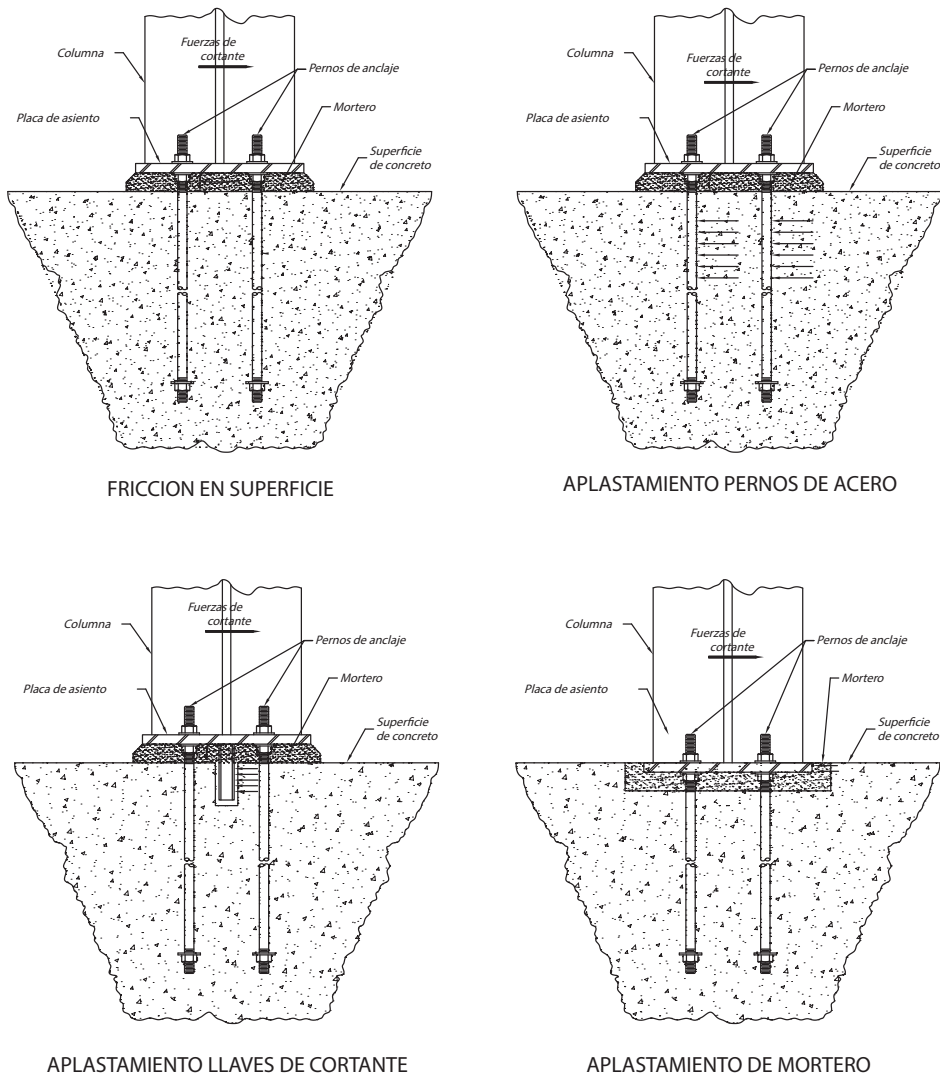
Mecanismos de transferencia de cortante en columnas apoyadas en la cimentación
